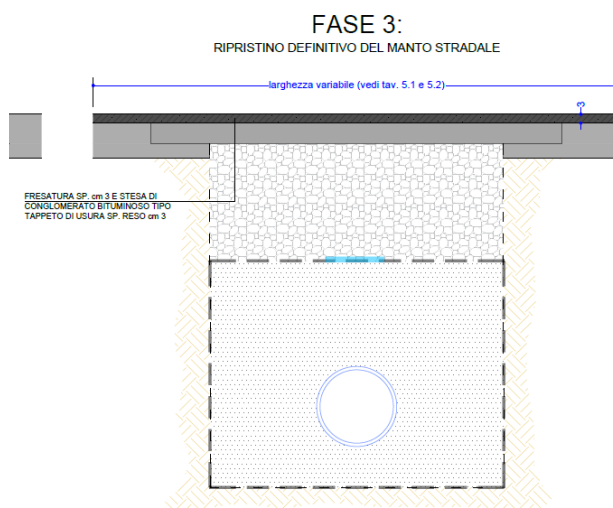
Sezione di scavo e ripristini in sede stradale – FASE 3
